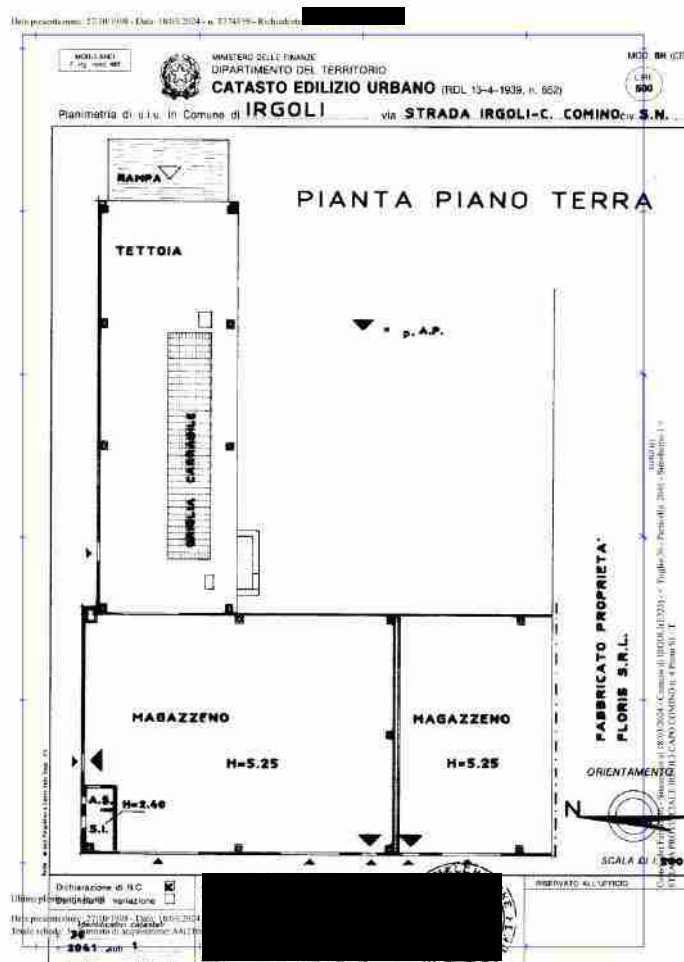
\_planimetria catastale del f.36 p.IIIa 2041 sub.1/parte (magazzino + tettoia)
